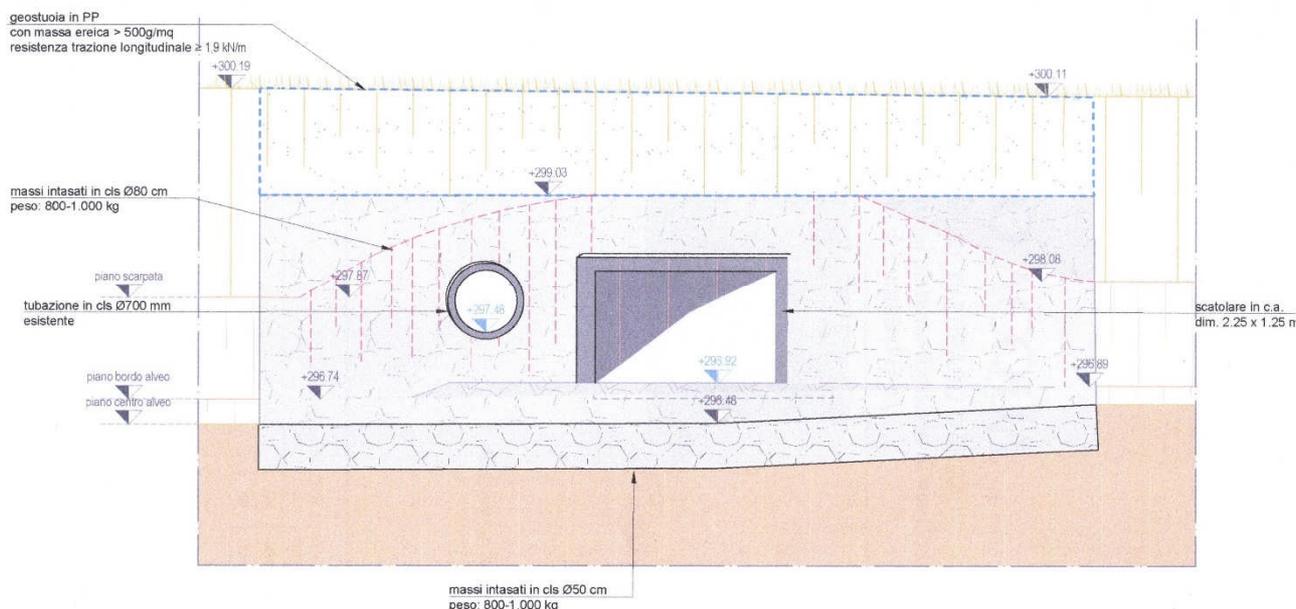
Progetto Rev. 09/2023 - Estratto sez. B-B manufatto di sbocco
